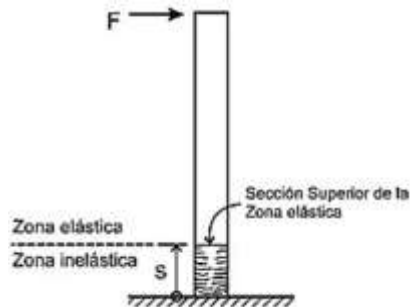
Columna de concreto con zona inelástica en el extremo inferior
